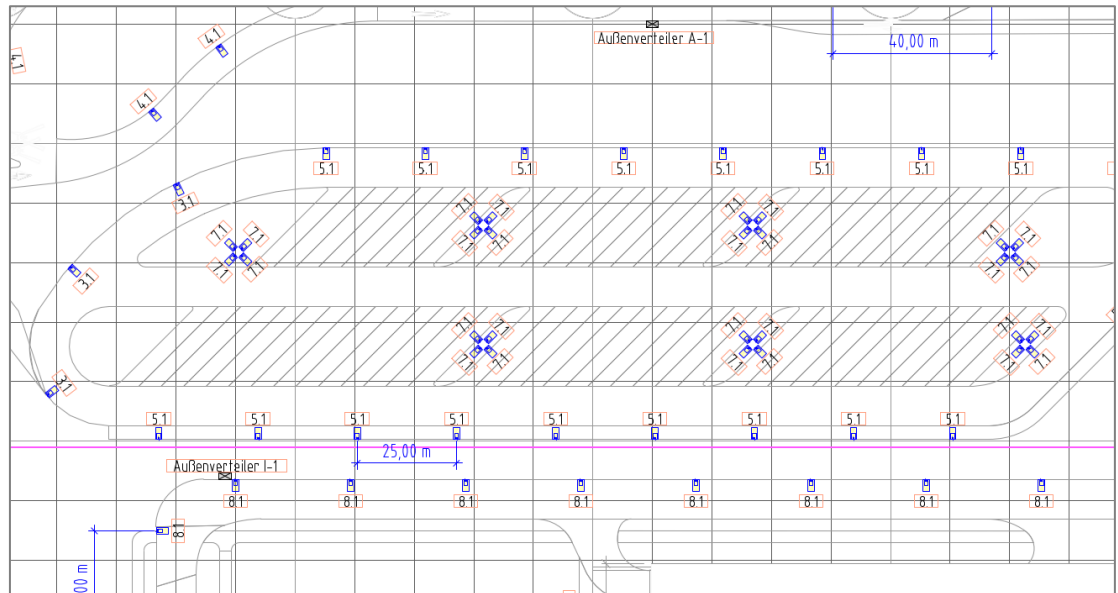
ELT-Masterplan, Lageplan Leuchten [4] – Ausschnitt.
